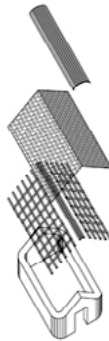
Levantamiento arquitectónico. Levantamiento estructural.
